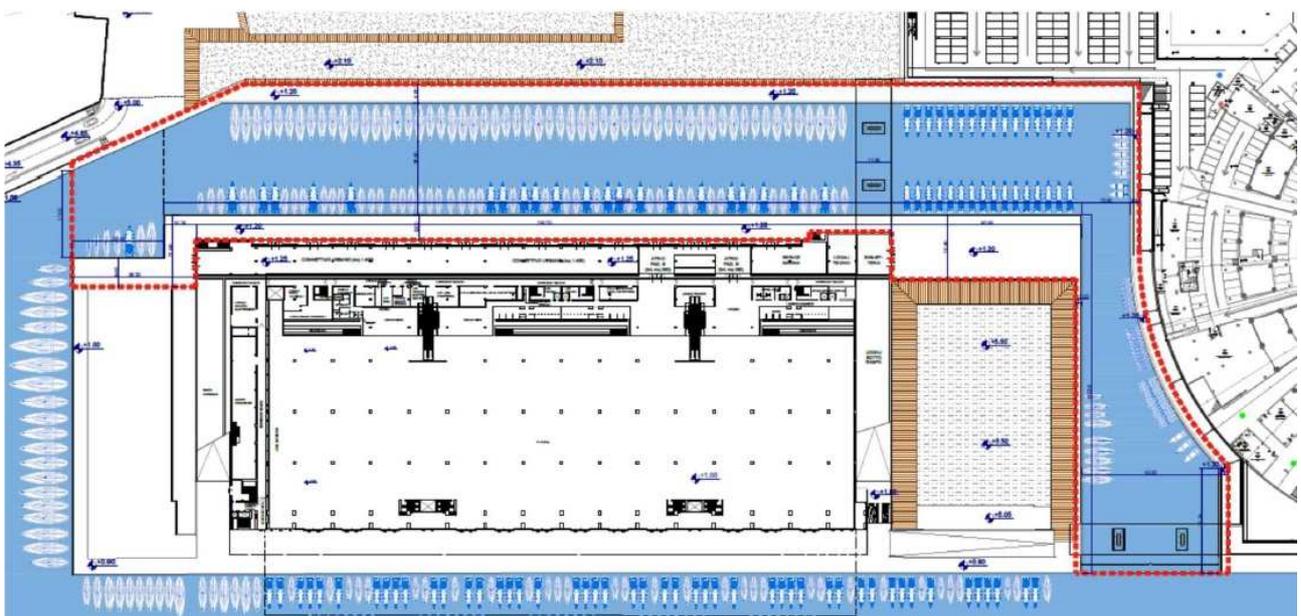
Planimetria di progetto a quota banchina – Stralcio elaborato Ar-T-05.
